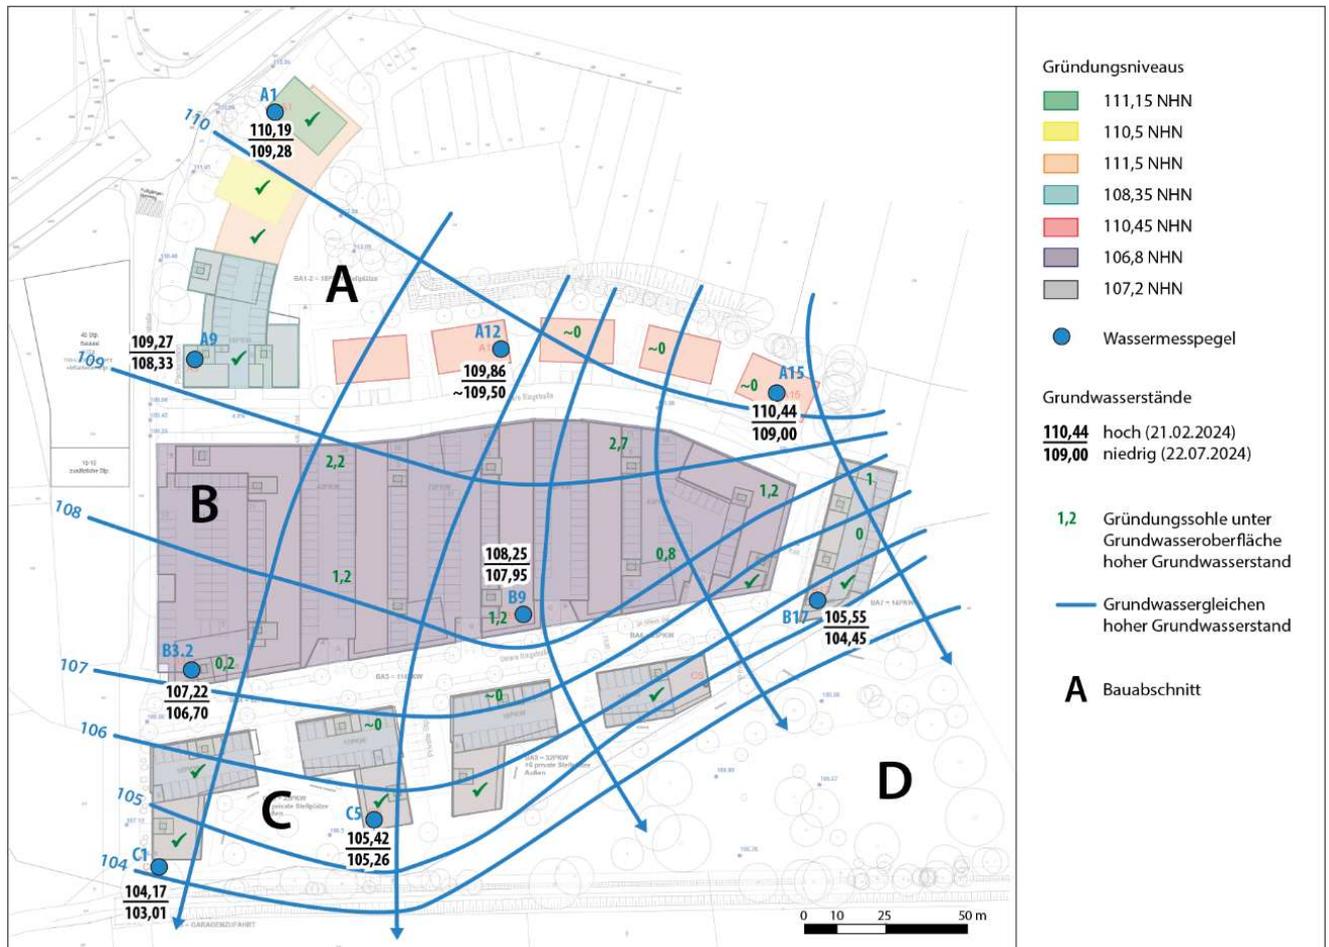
Grundwassergleichplan und Lage der Gründungssohlen im Verhältnis zur Grundwasseroberfläche (Quelle: Ten Brinke, Ergänzung ahu GmbH)
